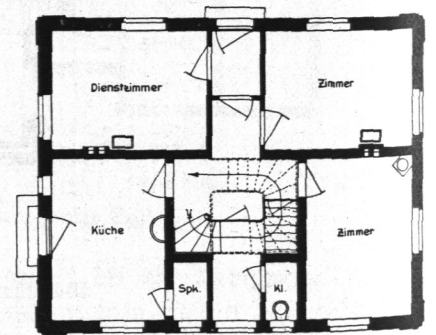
Schleusenwärterwohnhaus Fuhsbüttel, Grundriß.
